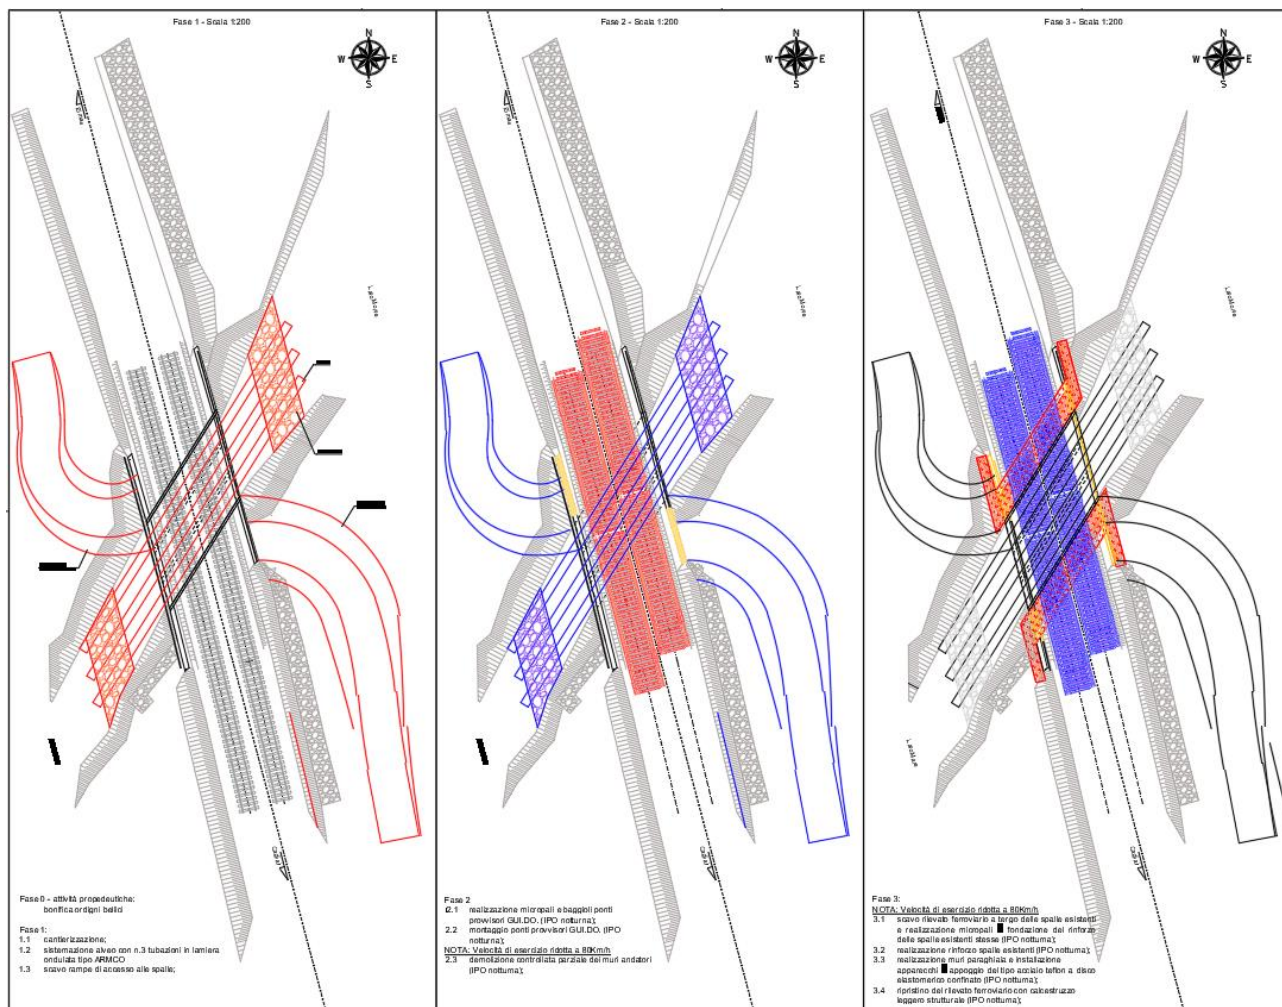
Stralcio planimetria fasi 0 1 2 3.
